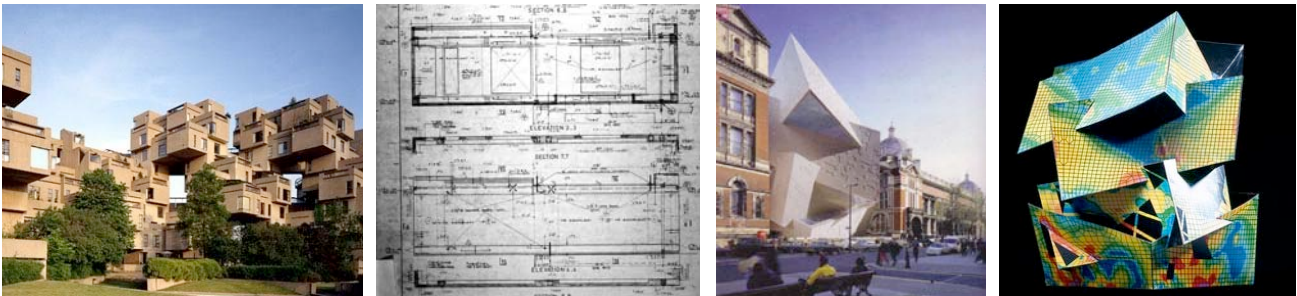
Habitat '67: (1) vista exterior y (2) plano de estructuras delineado a mano. Museo Victoria & Albert: (3) vista exterior de la propuesta y (4) maqueta modelo FEM.
